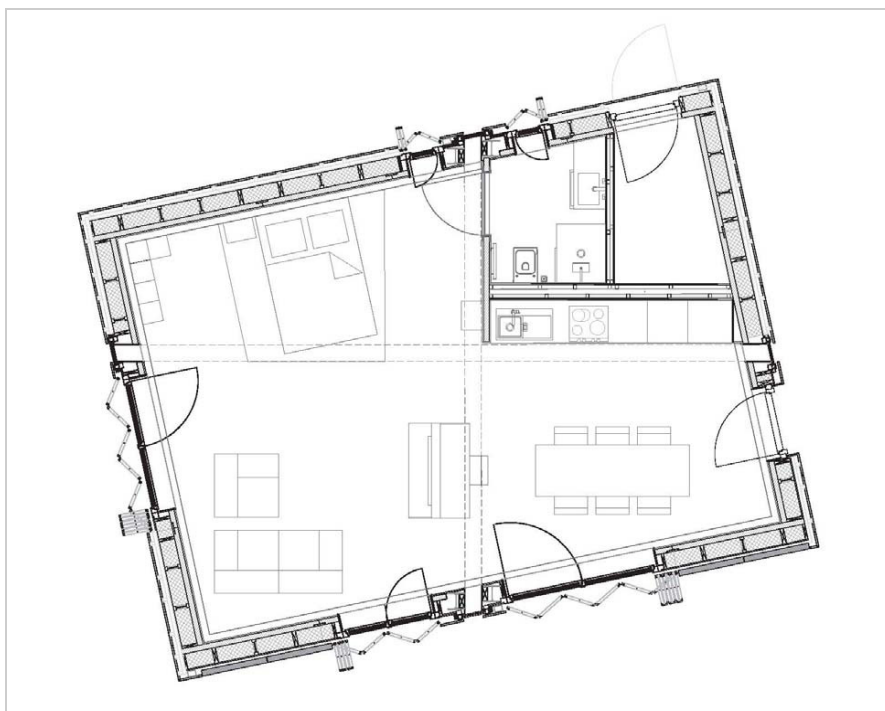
Grundriss des »living EQUIA«-Hauses: Ein-Raum-Wohnung; Grundfläche 74 m², davon ca. 46 m² Wohnfläche; flexible, individuelle Wohnraumaufteilung; Funktionskubus im Nordosten
